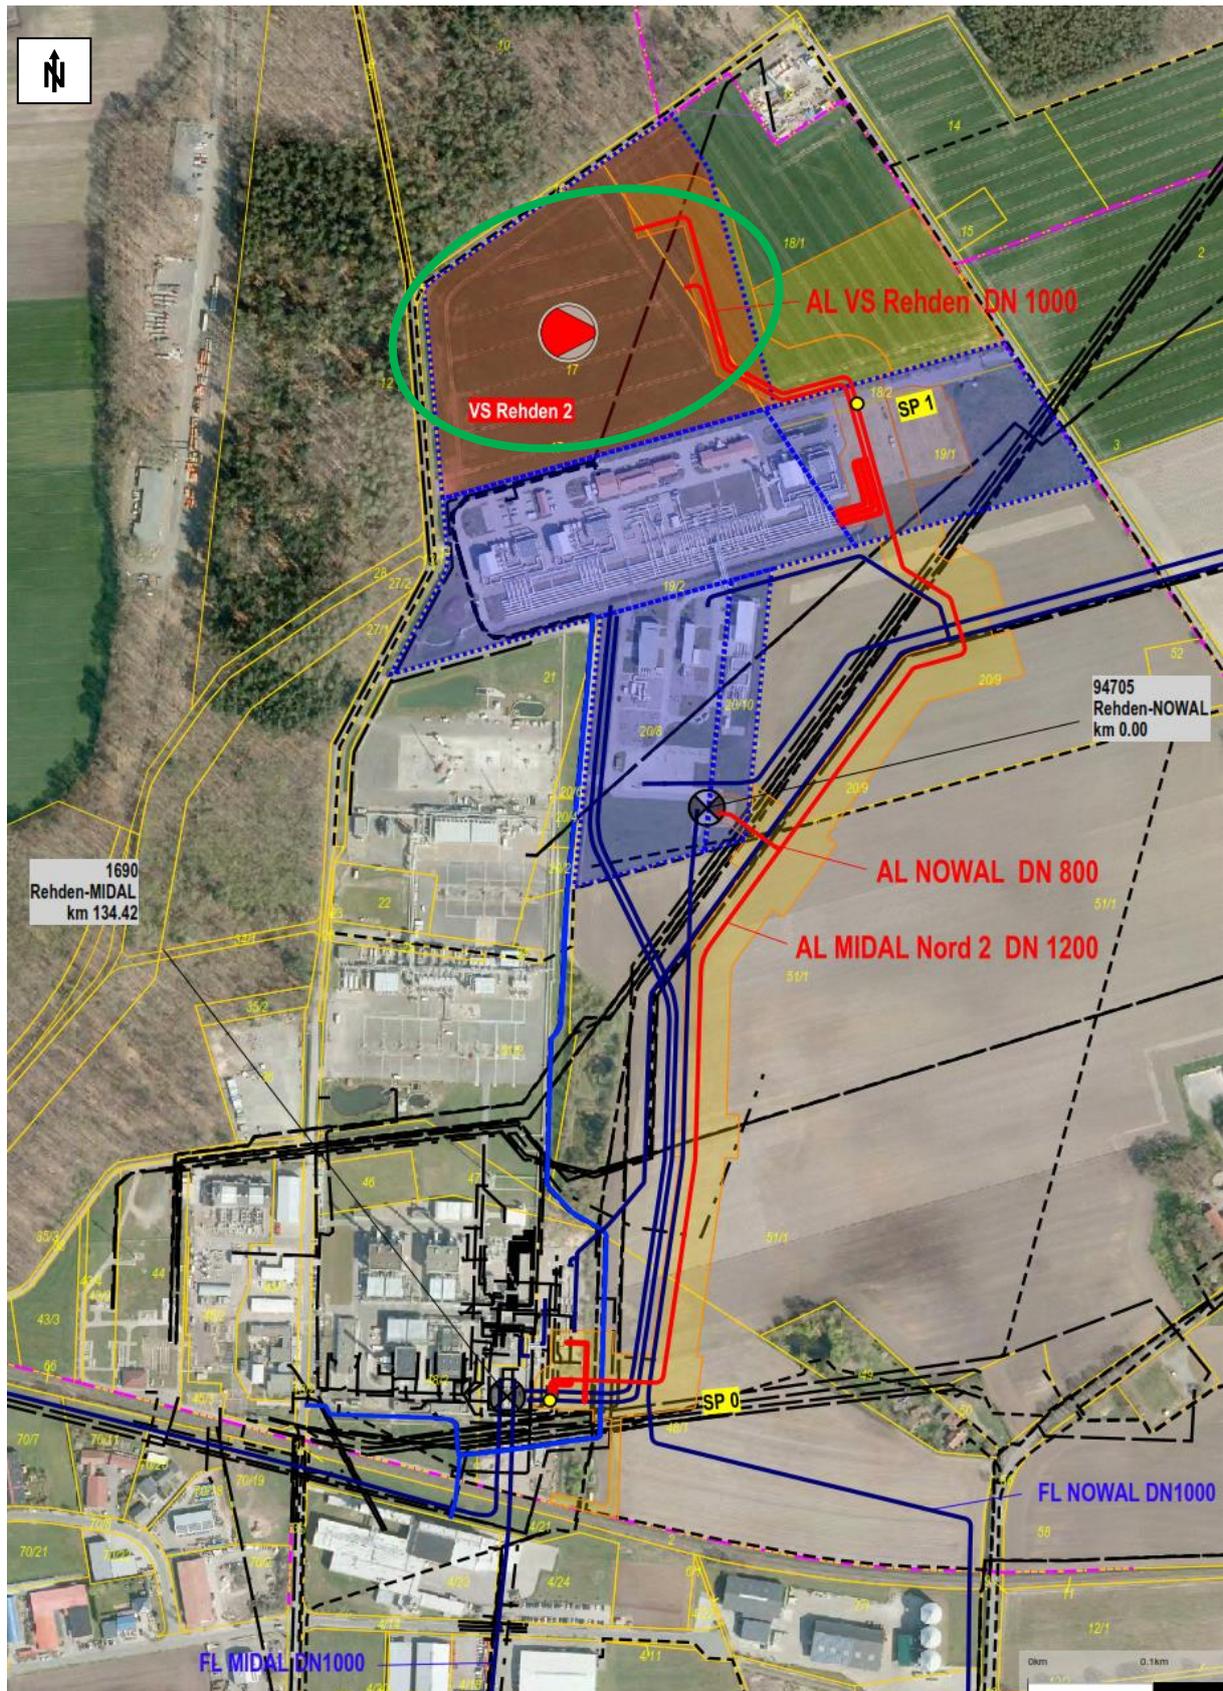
Lageplan mit Erweiterungsfläche /3.11/
